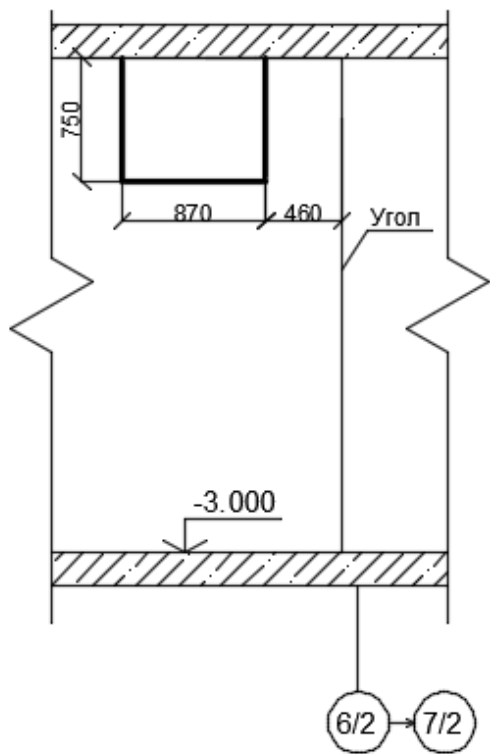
Фундаментная плита 8, 9, 10 секции
